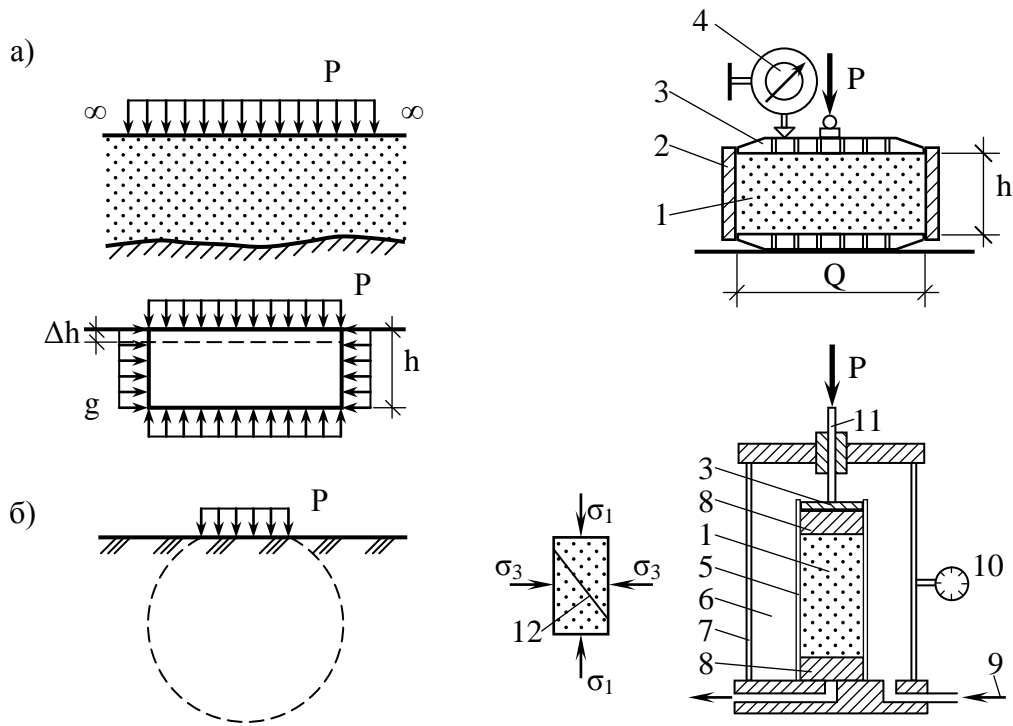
Основні схеми стиснення ґрунту та прилади, що його моделюють: *a* – рівномірно розподіленим суцільним навантаженням без можливості бічного розширення – компресійне стиснення ґрунту в одометрі; *б* – навантаження, що передаються на обмежену поверхню ґрунту – стиснення в стабілометрі; 1 – ґрунт; 2 – кільце; 3 – дірчатий поршень; 4 – індикатор; 5 – гумова оболонка; 6 – рідина; 7 – прозорий циліндр (камера); 8 – фільтр; 9 – подача рідини під тиском; 10 – манометр; 11 – шток для створення вертикального тиску; 12 – площина зрушення
